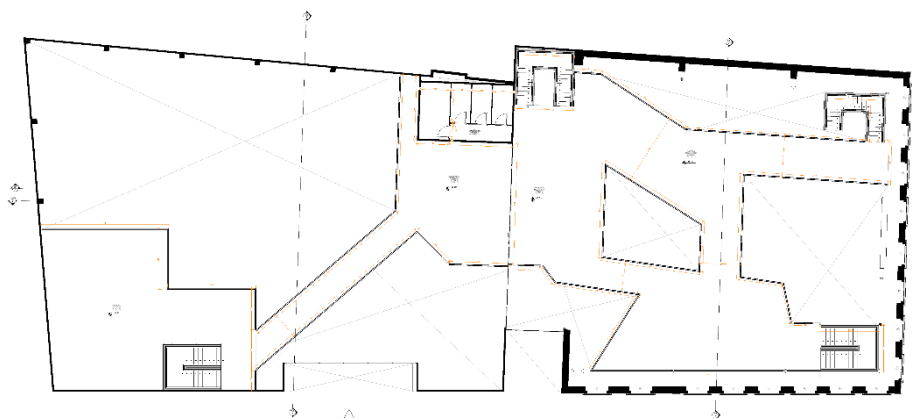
Planta Baixa, Mezanino II, Fonte: Elaboração Autoral, 2023
